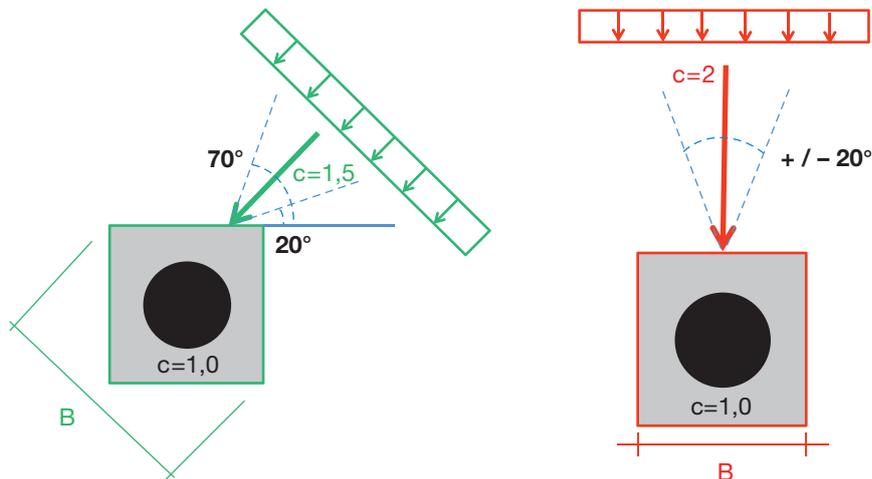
Grundriss Rohrstütze und hochgezogener Betonsockel sowie verschiedene Lawenfließrichtungen: Bereiche des Betonsockels mit Widerstandskoeffizienten $c = 1,5$ und $c = 2$; die Sockelbreite B ist jeweils senkrecht zur Lawinenfließrichtung zu berücksichtigen. Widerstandskoeffizient für Rohrstütze $c = 1$.
